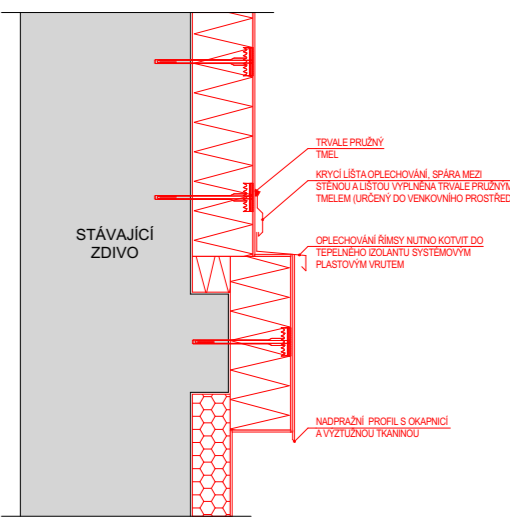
DETAIL BALKONOVÉ KONSTRUKCE - D.1
